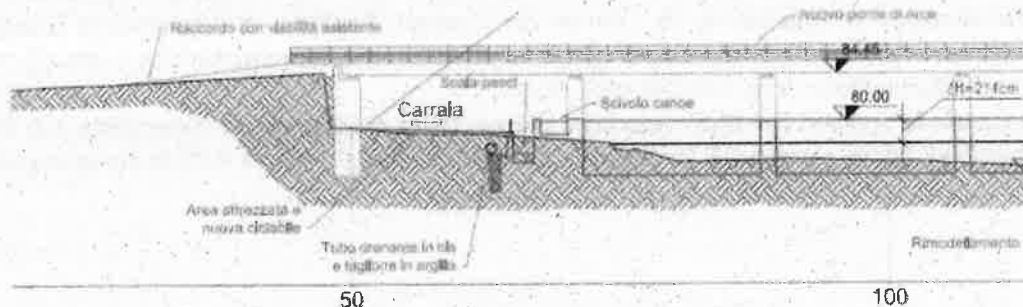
\_ Sezione di progetto della sistemazione della strada alzaia a monte della traversa di Arcè, particolare
